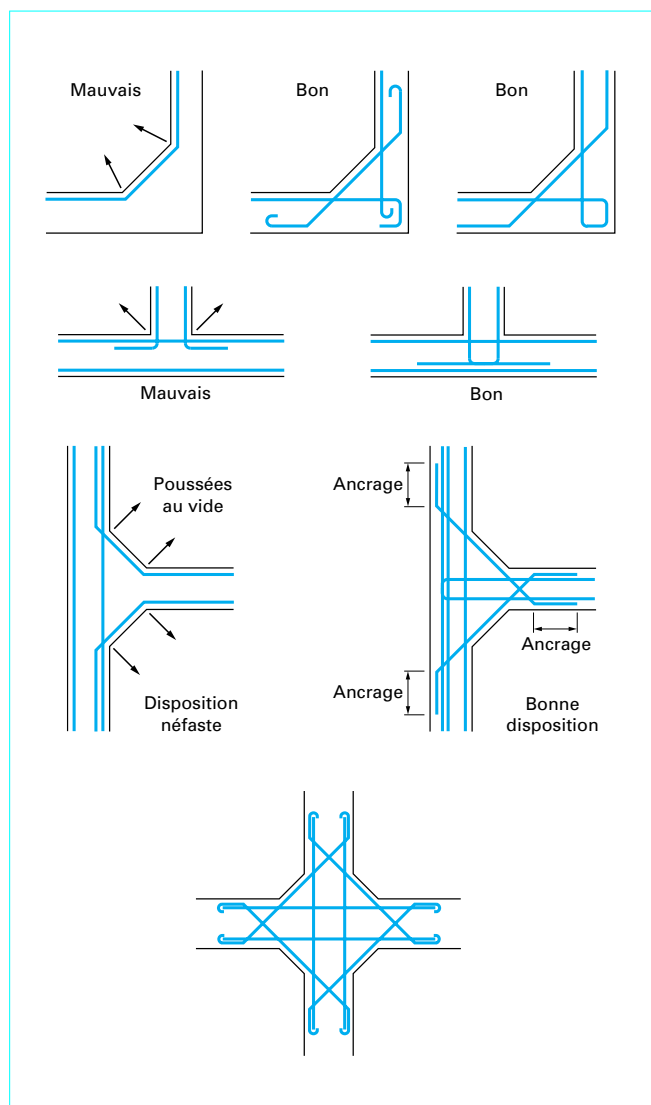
Ferrailage de parois encastrées et de parois d'angle
